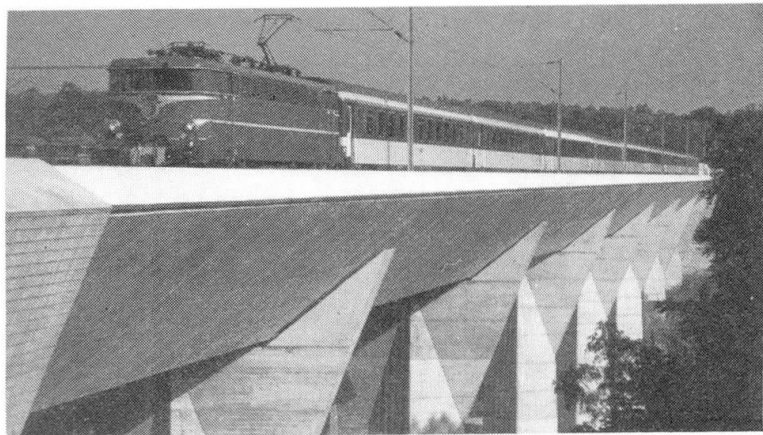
Ligne de Paris à Lille, Viaduc de Commelles – Caisson en béton précontraint pour 4 voies, Long. 400 m
